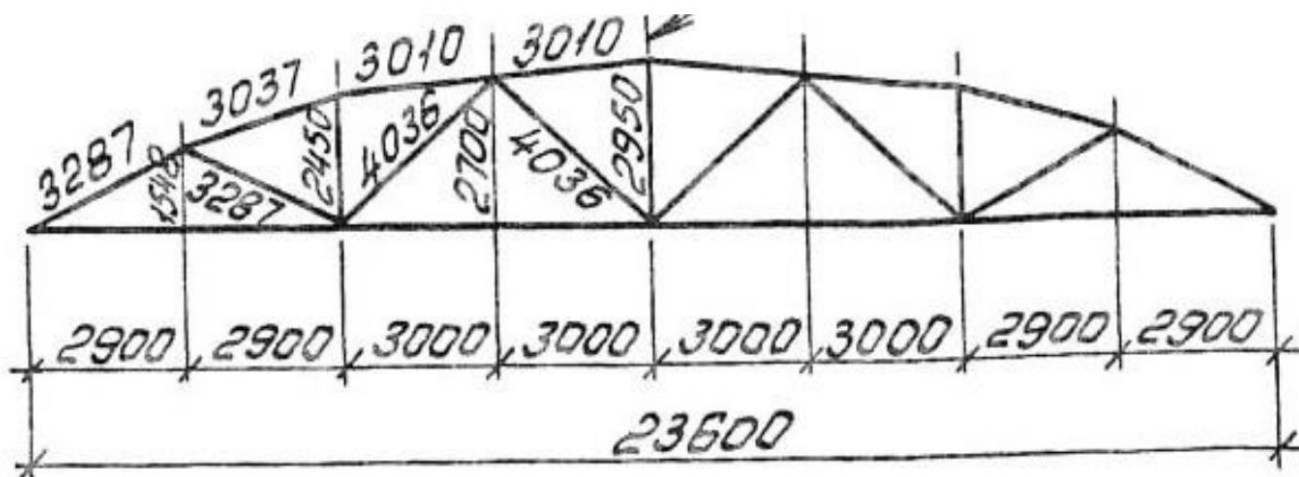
а) Загальний вигляд залізобетонної розкісної ферми Ф-2;
